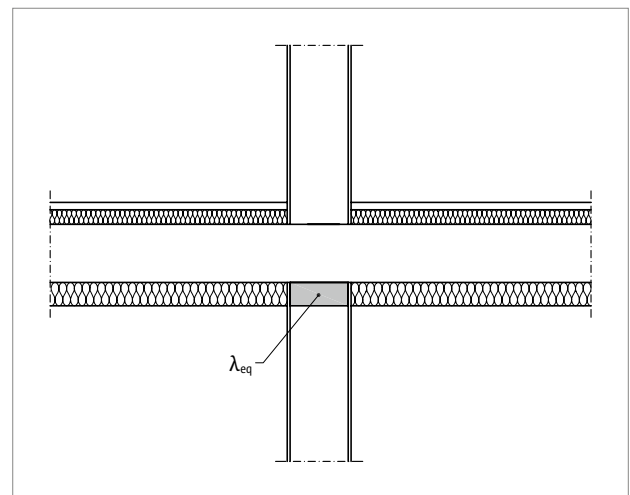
Darstellung einer Schnittzeichnung mit vereinfachtem Ersatzdämmkörper
